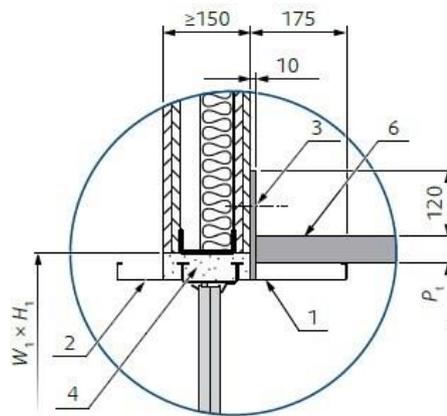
(EI120S) Sezione trasversale per ☉ installazione umida in parete flessibile
